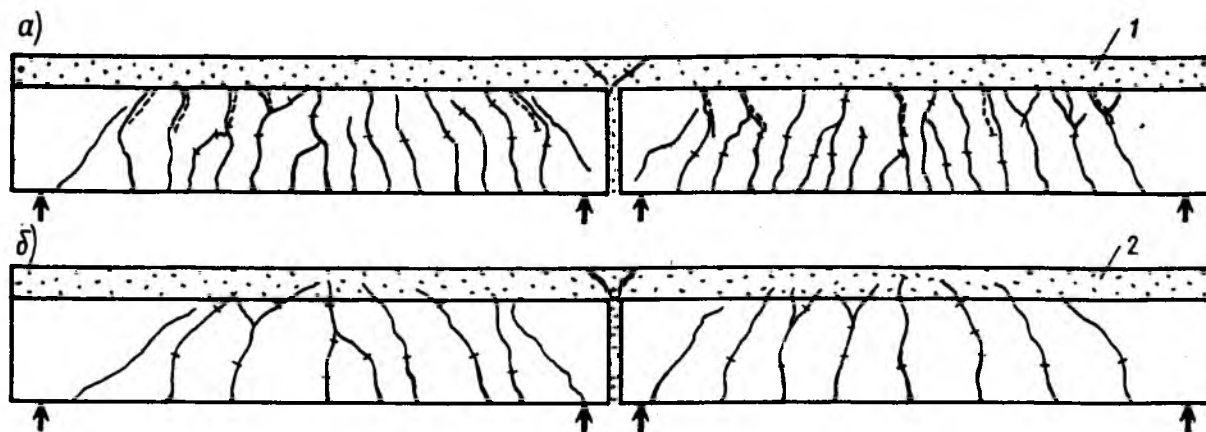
Трещинообразование неразрезных фрагментов с монолитной частью из напрягающего бетона (а) и из бетона на портландцементе (б)
